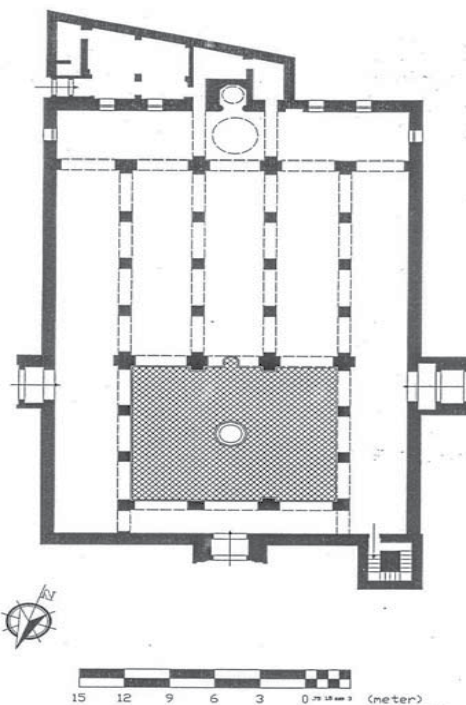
جامع قرطبة، مسقط أفقي عهد الحكم
